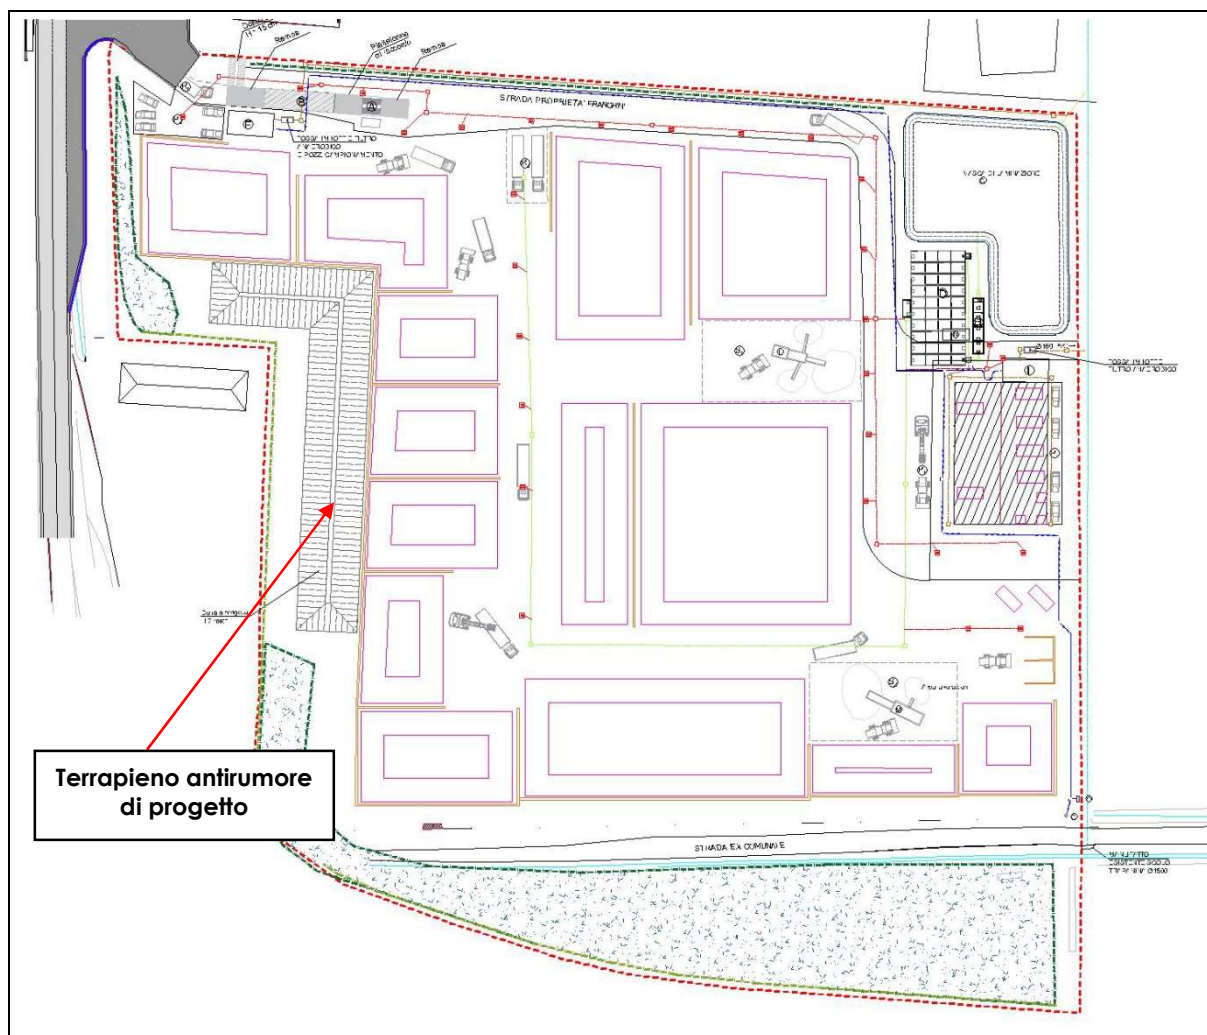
Disposizione in pianta del terrapieno antirumore di progetto
